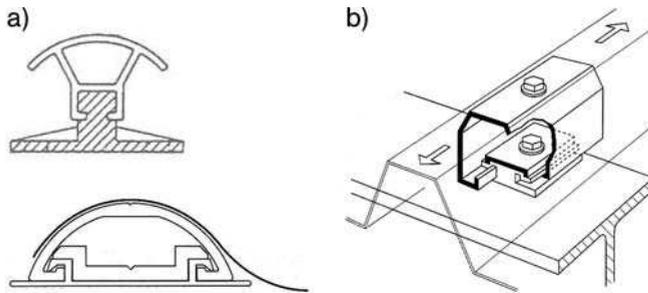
Schiebegarnituren zur Befestigung von Aluminiumprofilen auf der Unterkonstruktion – a) Wellprofile, b) Trapezprofile
